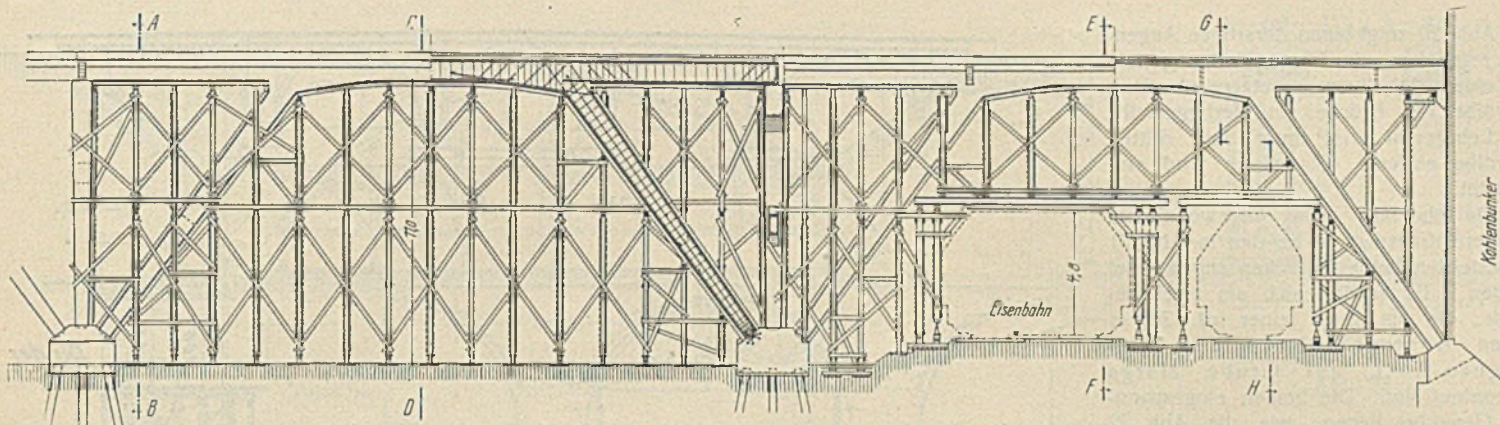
Längsschnitt und Einrüstung der beiden zweigleisigen Felder vor dem Kohlenbunker.
